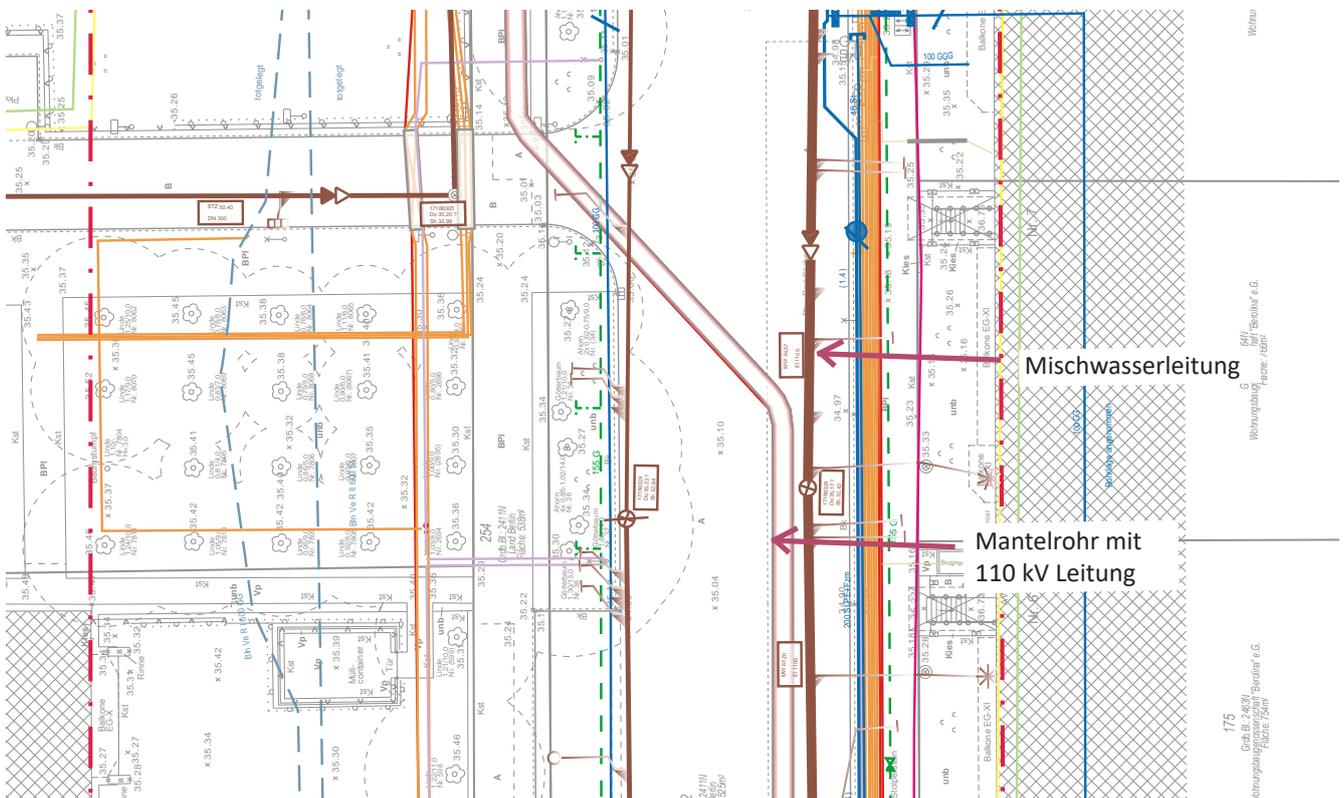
Ausschnitt aus koordiniertem Leitungsplan mit Stromtrasse und Mischwasserkanal, 2021, Quelle: Gruppe Planwerk
